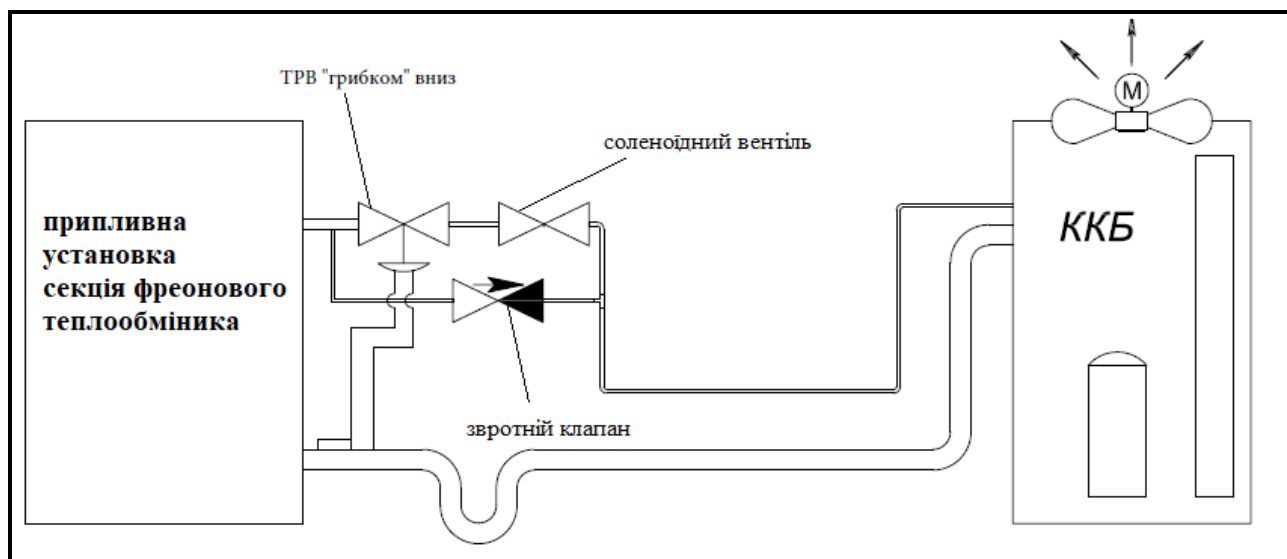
Схема обв'язки випарника для роботи з реверсивним ККБ.
